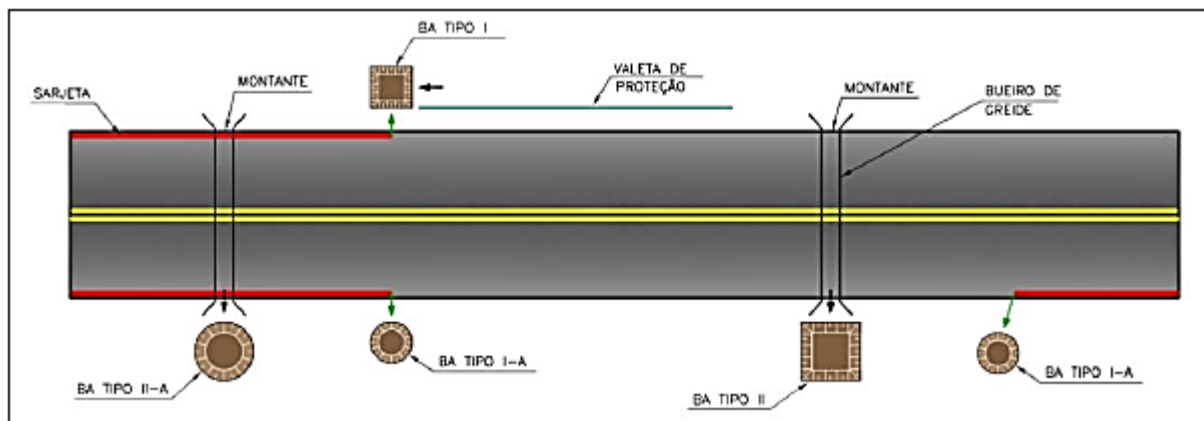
Croqui esquemático de locação de bacias de acumulação.
